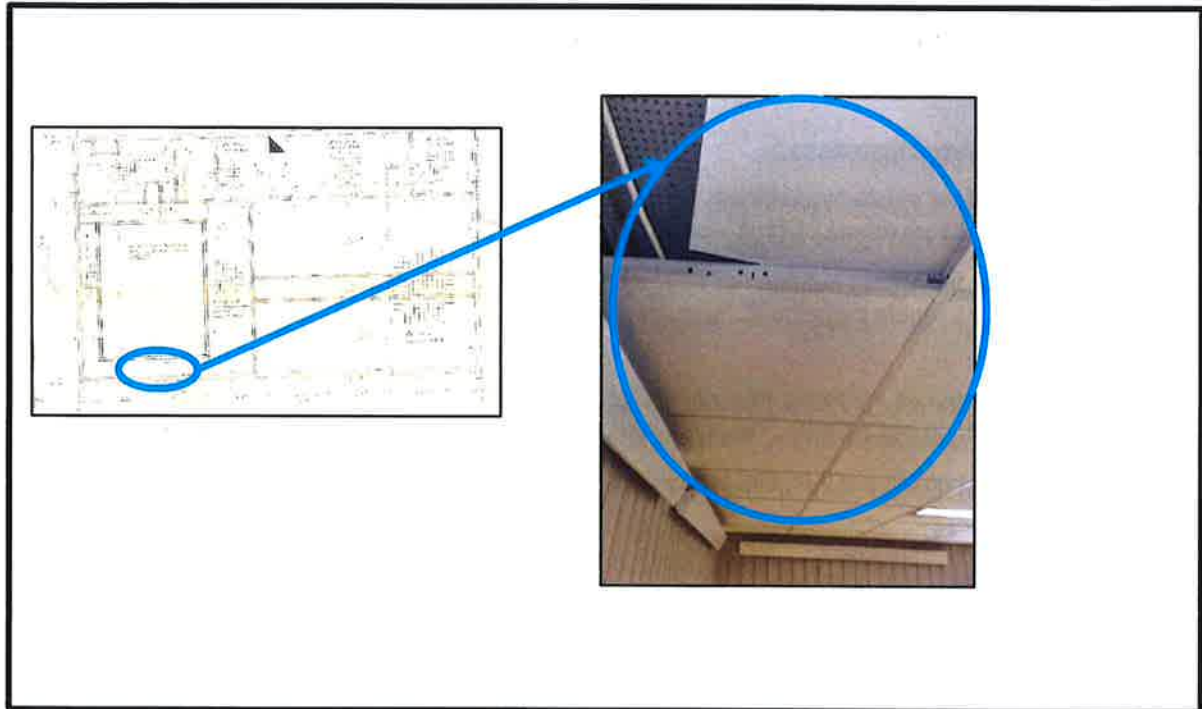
Skade i betongdekker, bassenggrube.
